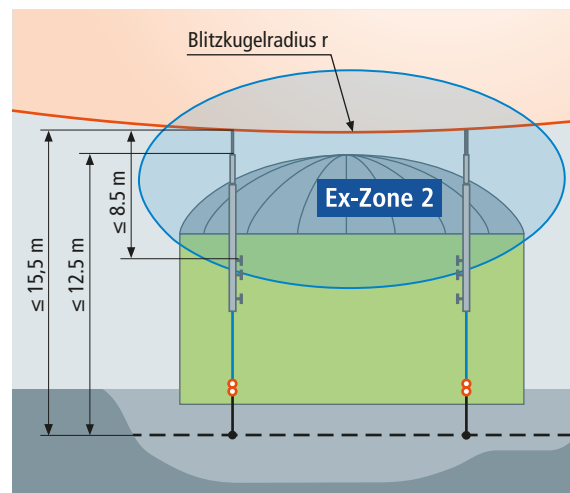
Schutz des Fermenters mittels Fangmaste, isoliert mit einer HVI-Leitung (Art.-Nr. 819 730)
